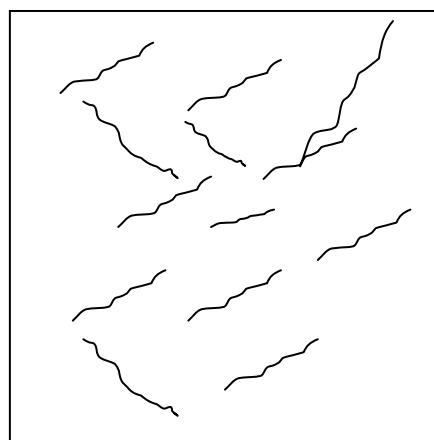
Fisuras de contracción plástica en una losa de hormigón
